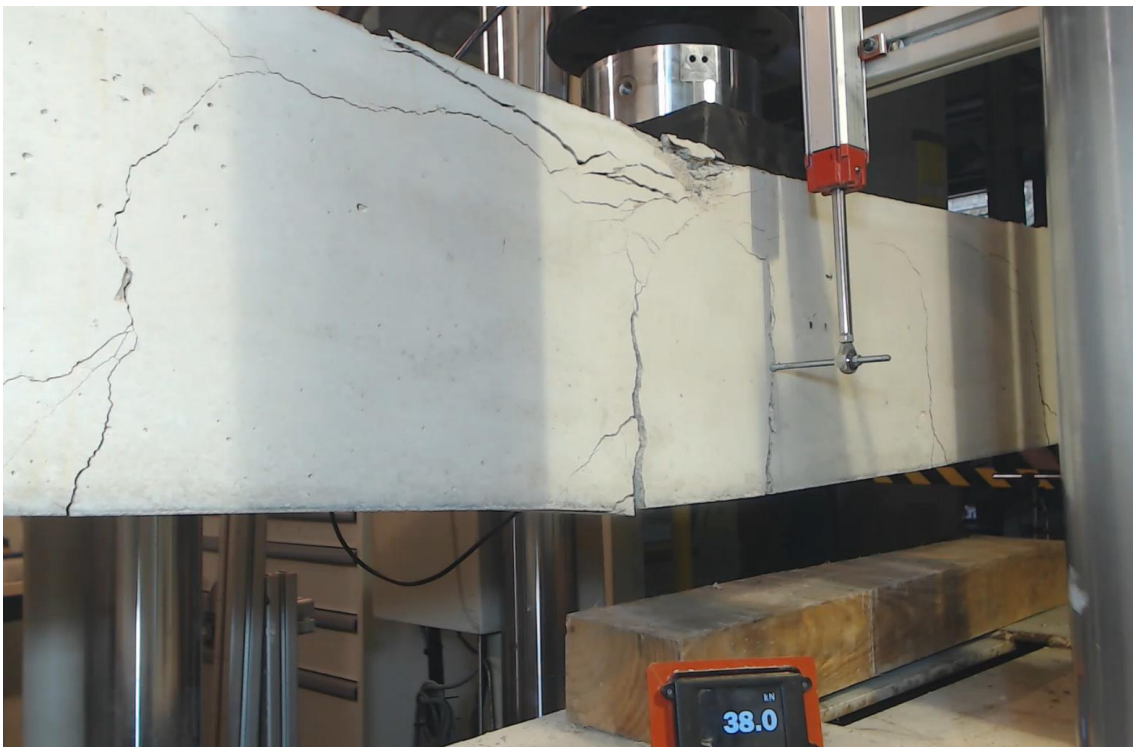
Fisuras Viga 3T13b a 38kN. Grupo 2.
